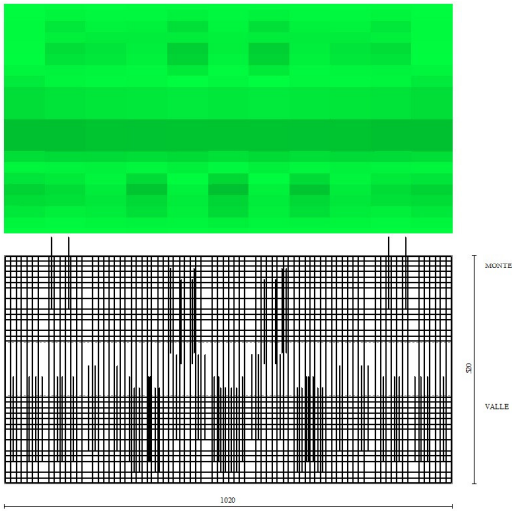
Piastra fondazione dir. Y (Inviluppo)
